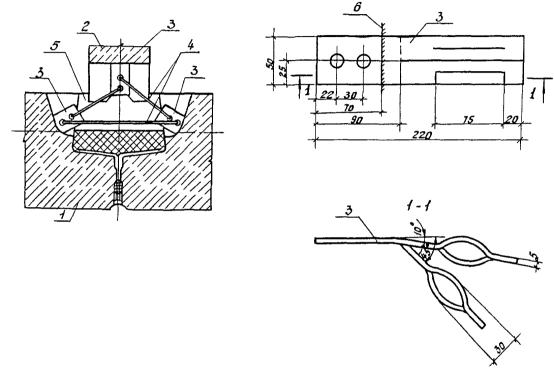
Стык однослойных панелей наружных стен со штампованными закладными деталями:
